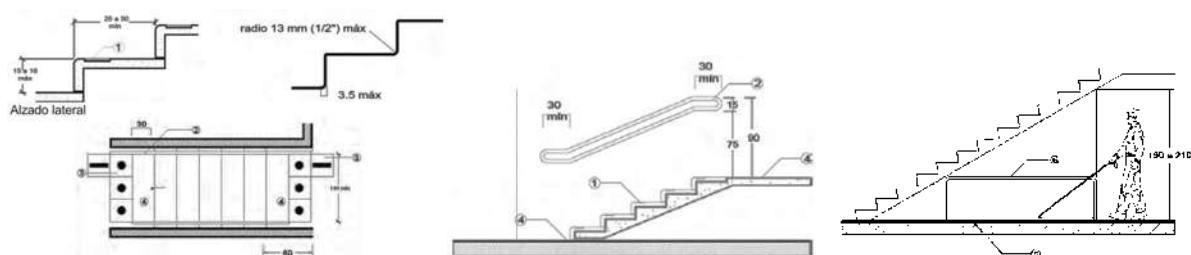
(1) Piso o franja antideslizante. (2) Pasamanos: extensión horizontal. (3) Pavimento táctil. (4) Área de aproximación. (5) Protección lateral. (6) Protección.
